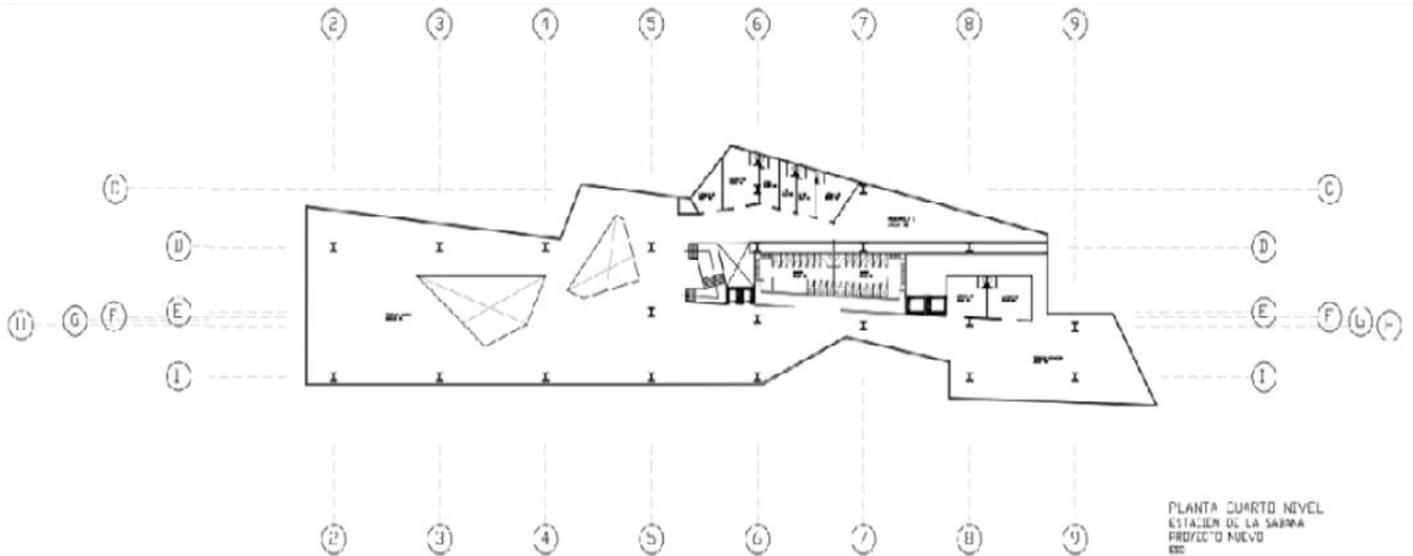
Planta Cuarto Nivel, proyecto nuevo. Estación de la Sabana.
